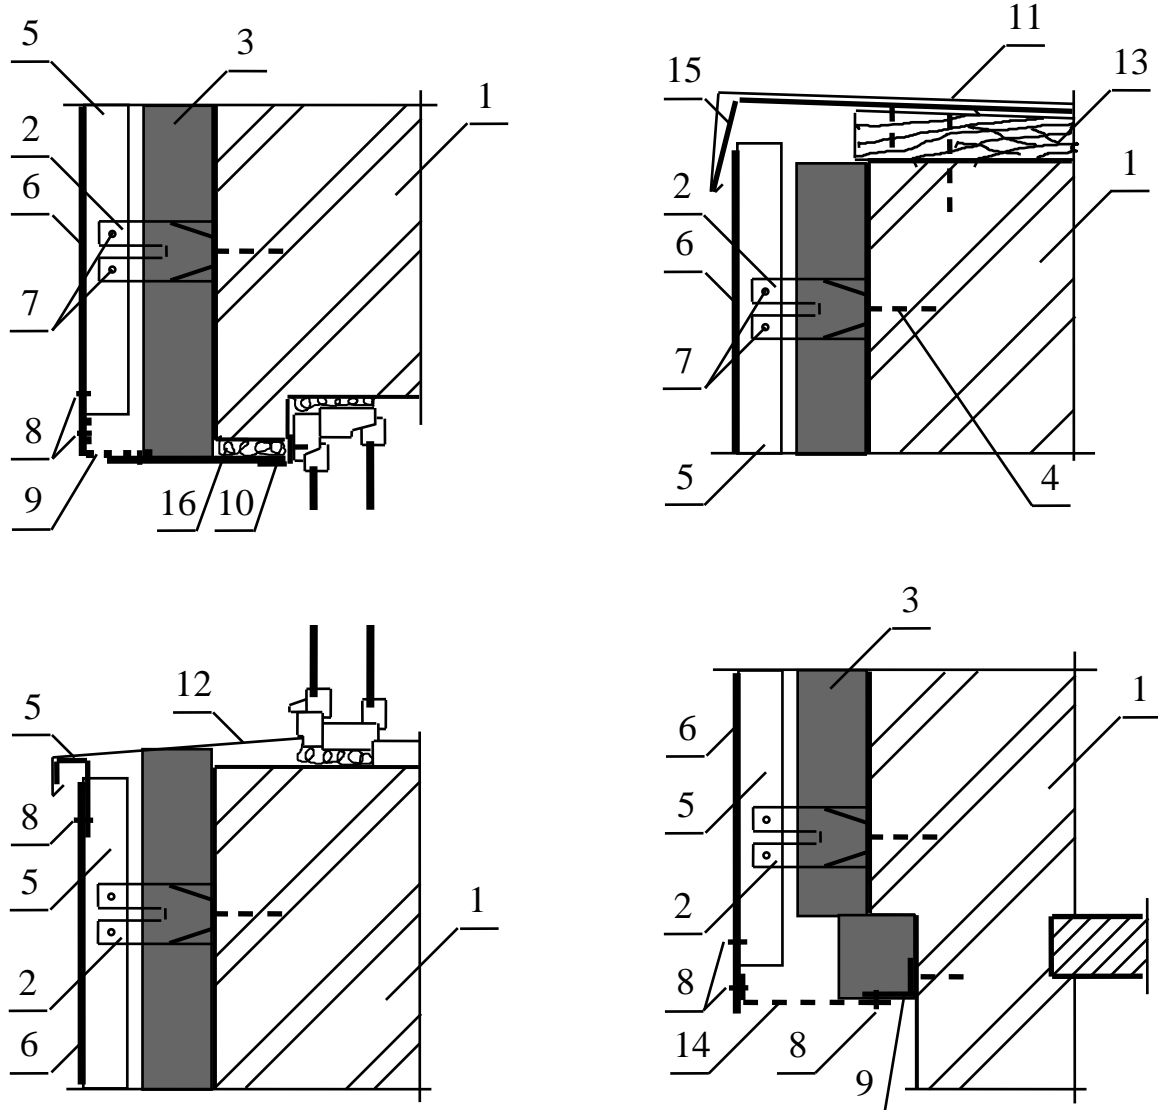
Вузли і деталі конструкції зовнішнього утеплення стін фірми “Термонта”: 1 – зовнішня стіна; 2 – консольний елемент кріплення; 3 – утеплювач негорючий; 4 – анкерний дюбель-гвинт; 5 – профіль несучий; 6 – виріб облицювальний; 7 – гвинти; 8 – заклепка; 9 – профіль L; 10 – профіль F; 11 – захисний елемент парпету; 12 – віконний відлив; 13 – дерев’яний брусоч; 14 – профіль вентиляційний; 15 – профіль кутовий; 16 – просмолена пакля
